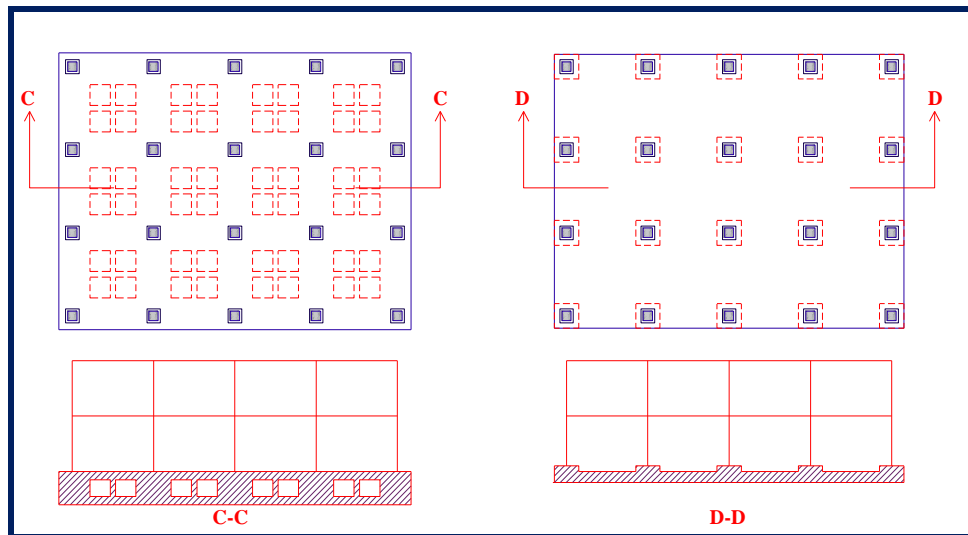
Modelamiento de zapata en planta y elevación, de una platea de cimentación corte C-C corte D-D.
